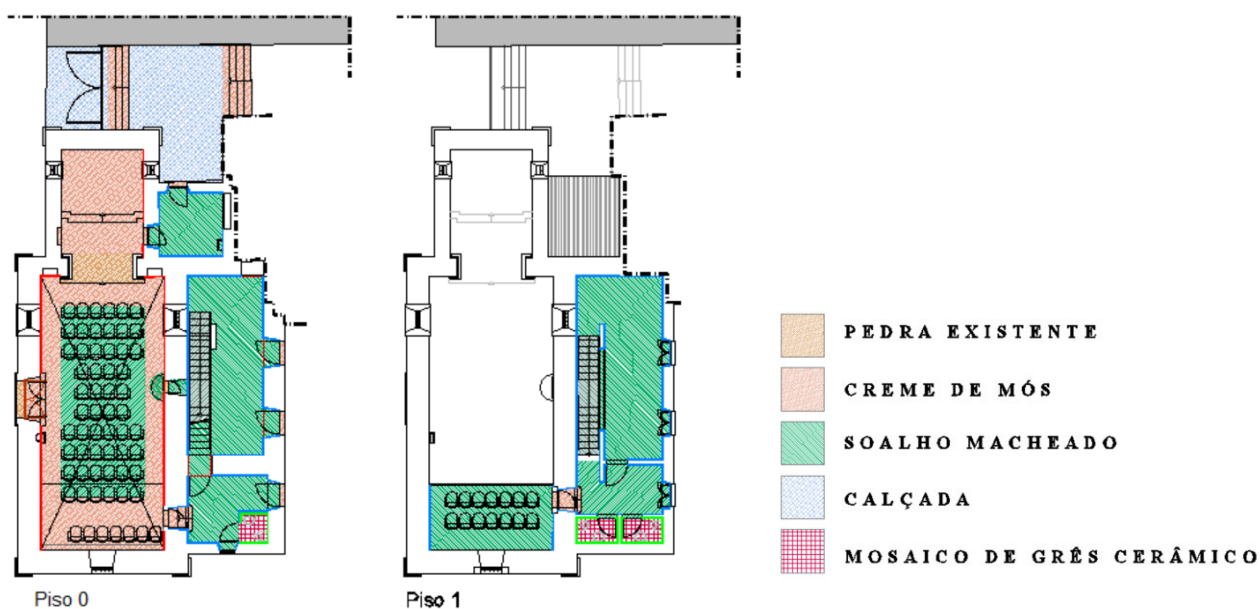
Planta de pavimentos capela (s/ escala) [25]
